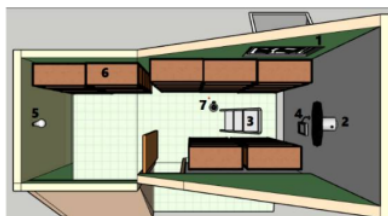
Desain baru 3D ruang filing 1 tampak atas
